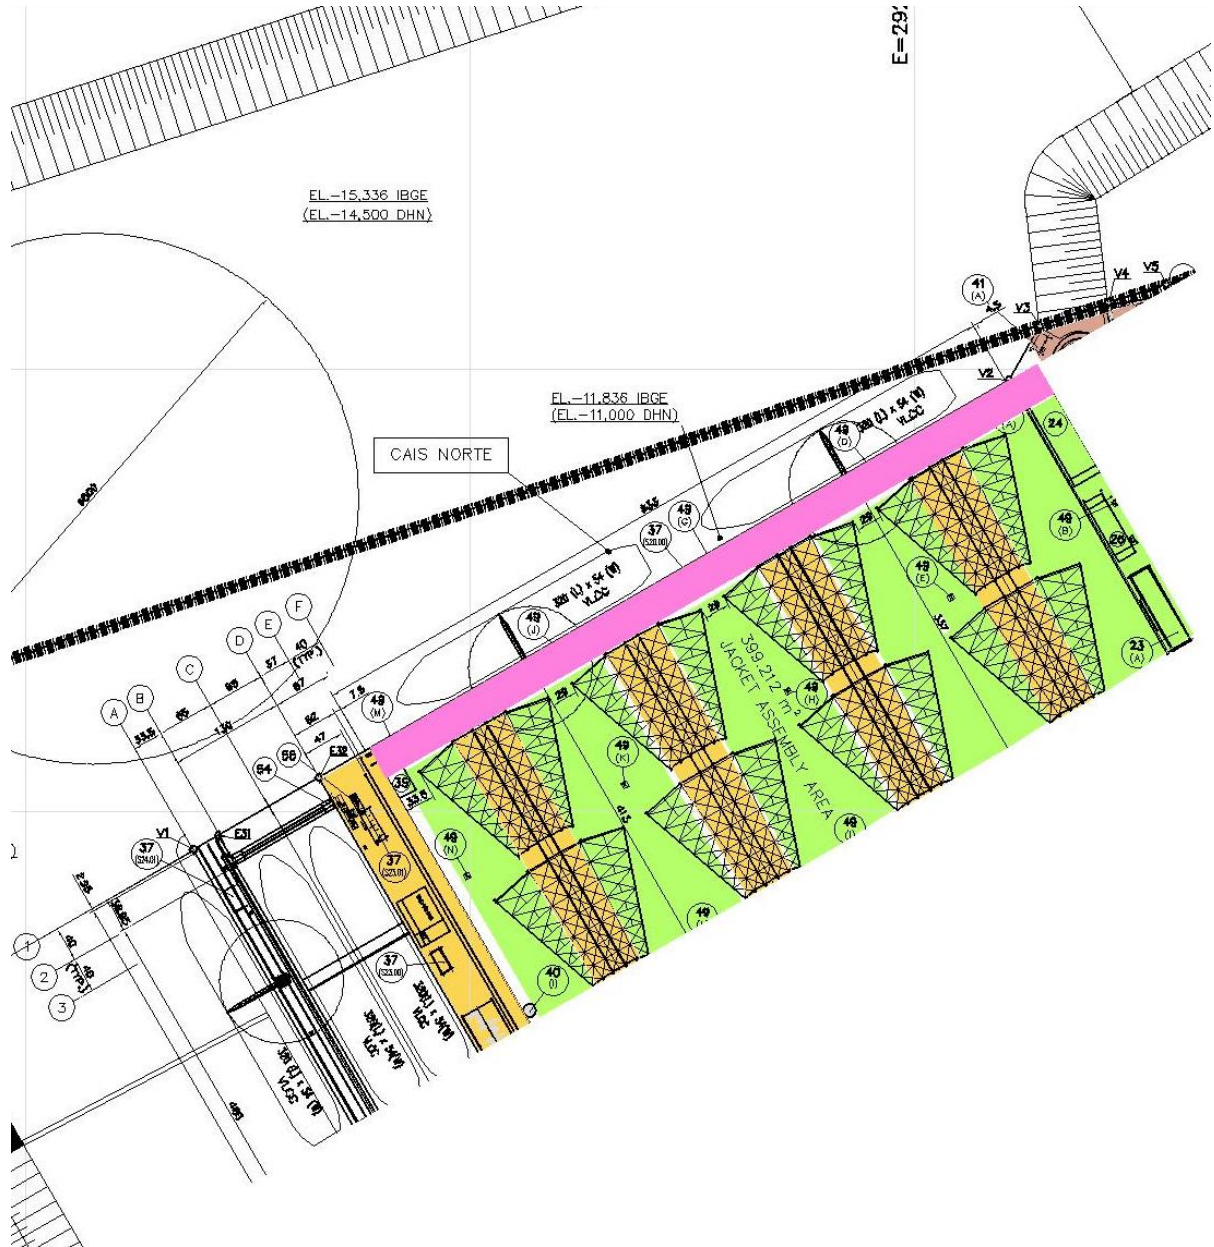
Planta de pavimentação da área de montagem de jaquetas. Fonte: Projeto OSX
